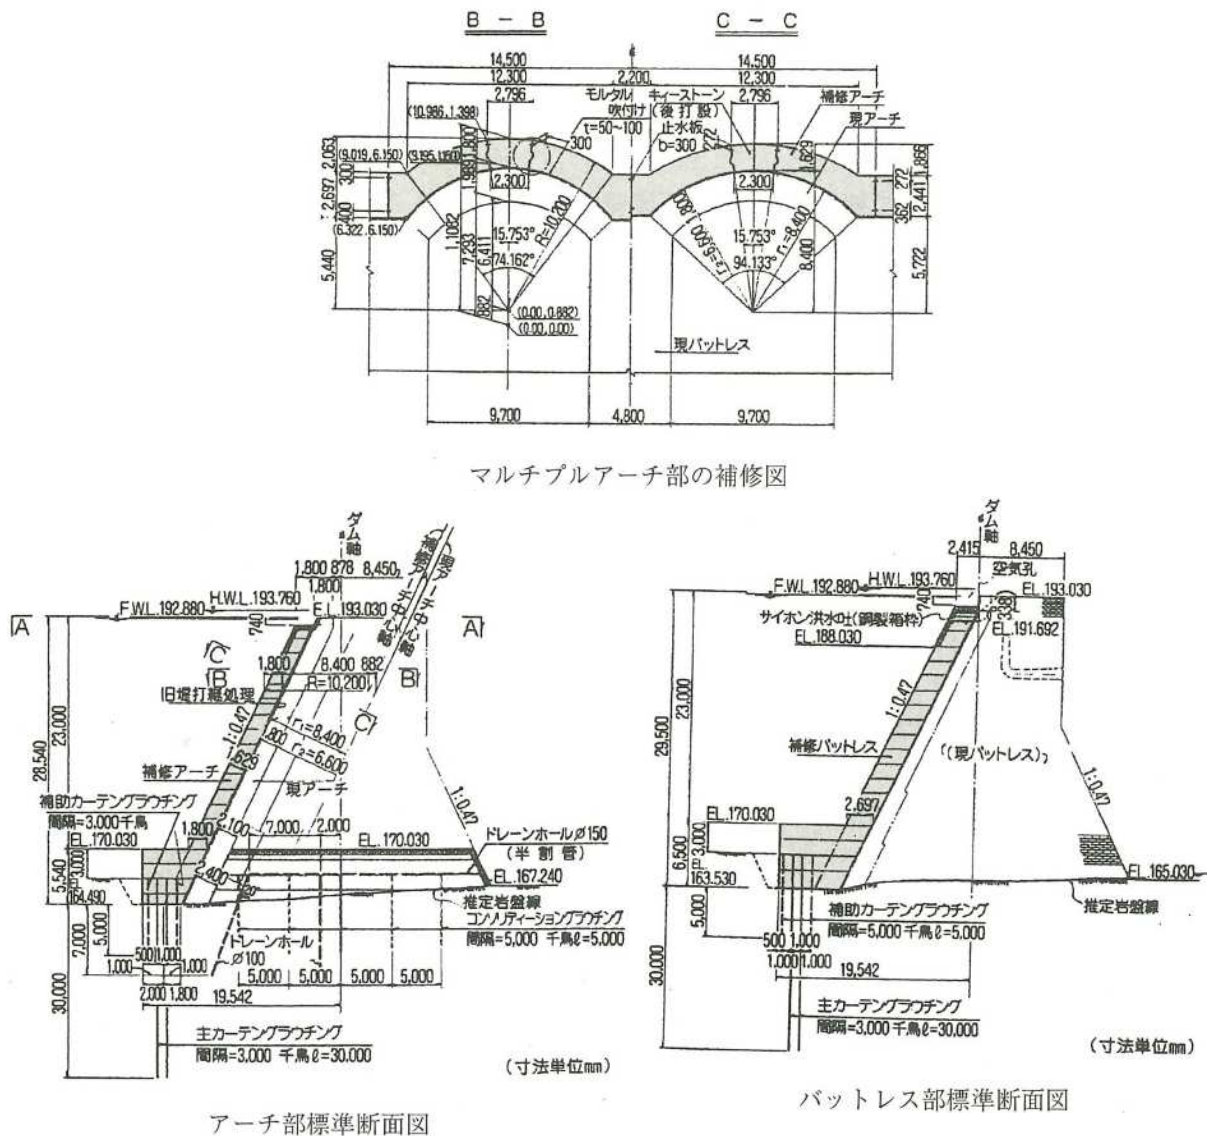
豊稔池ダム補修概要図（網掛け部：上流新設コンクリート）
